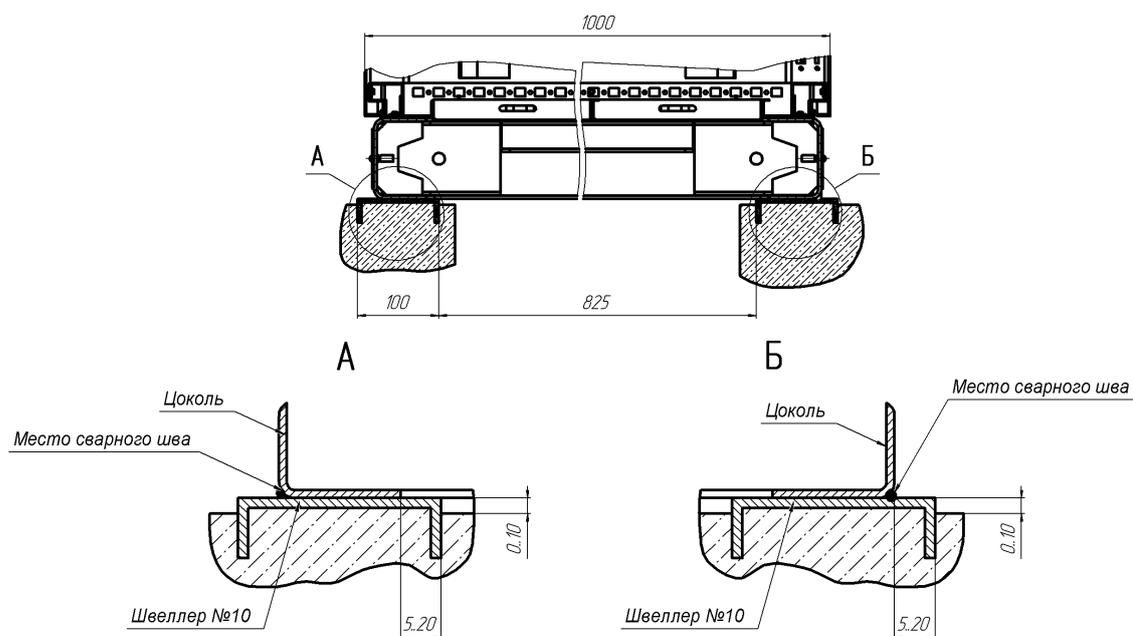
Установка ШСПД при помощи сварки
